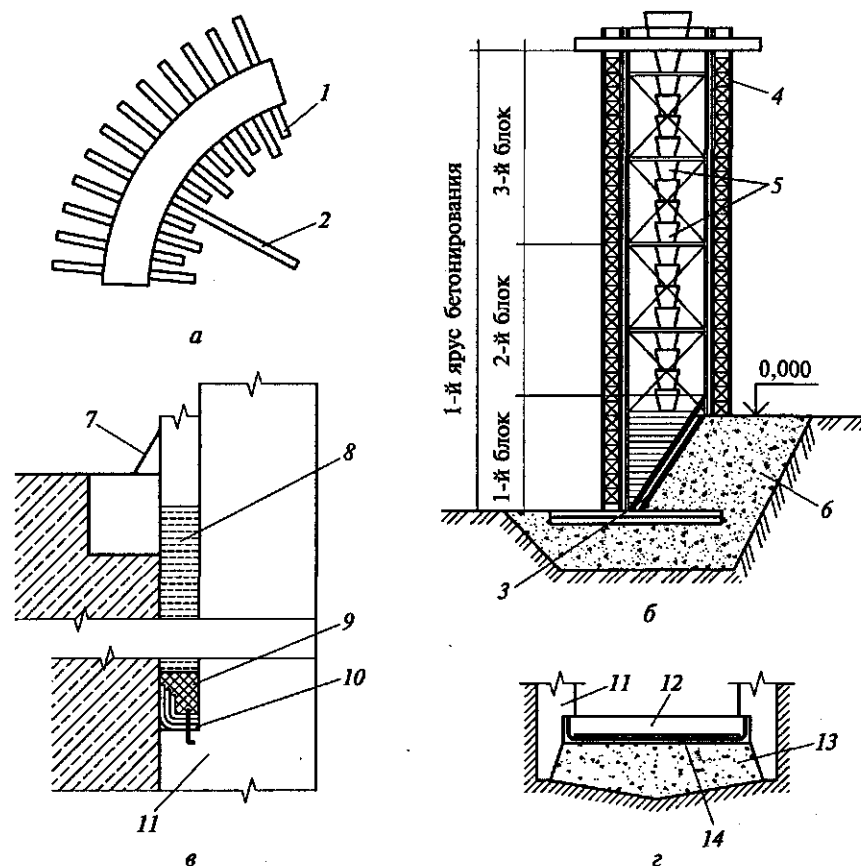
Возведение монолитных железобетонных колодцев:
